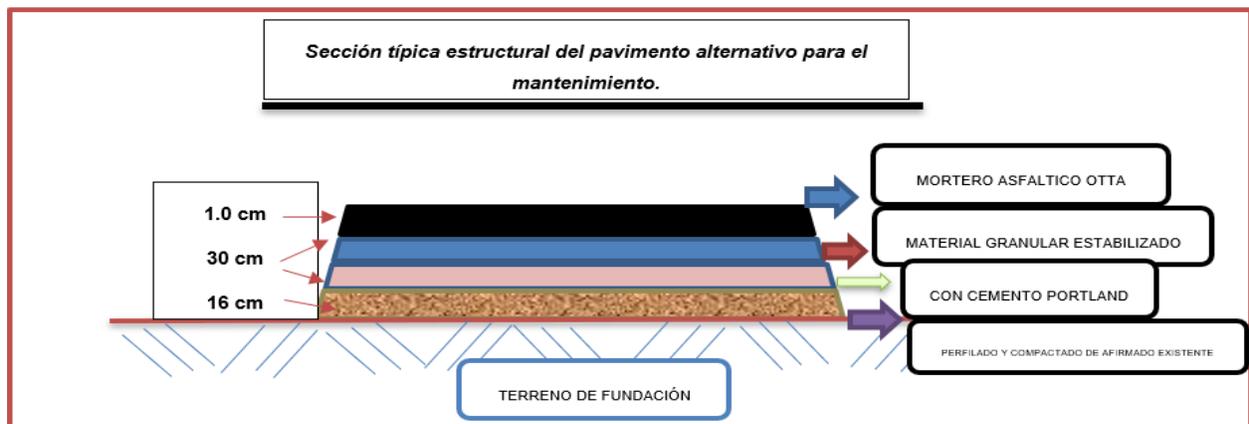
Sección típica de la estructura de pavimento ara el mantenimiento.
